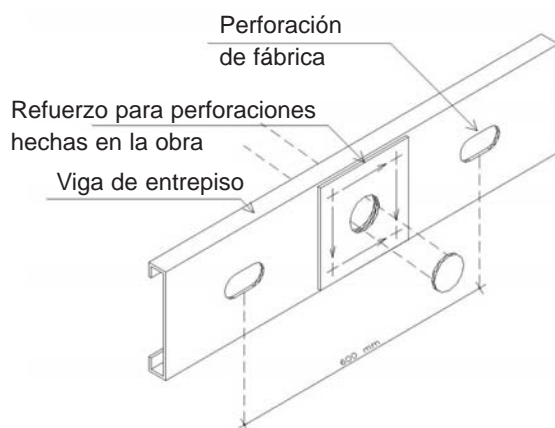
Detalle de refuerzo en viga de entrepiso.
